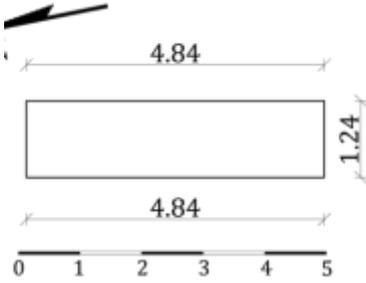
مسقط أفقي للمنور بدهليز المدخل بزواوية فرج (عمل الباحثة)
